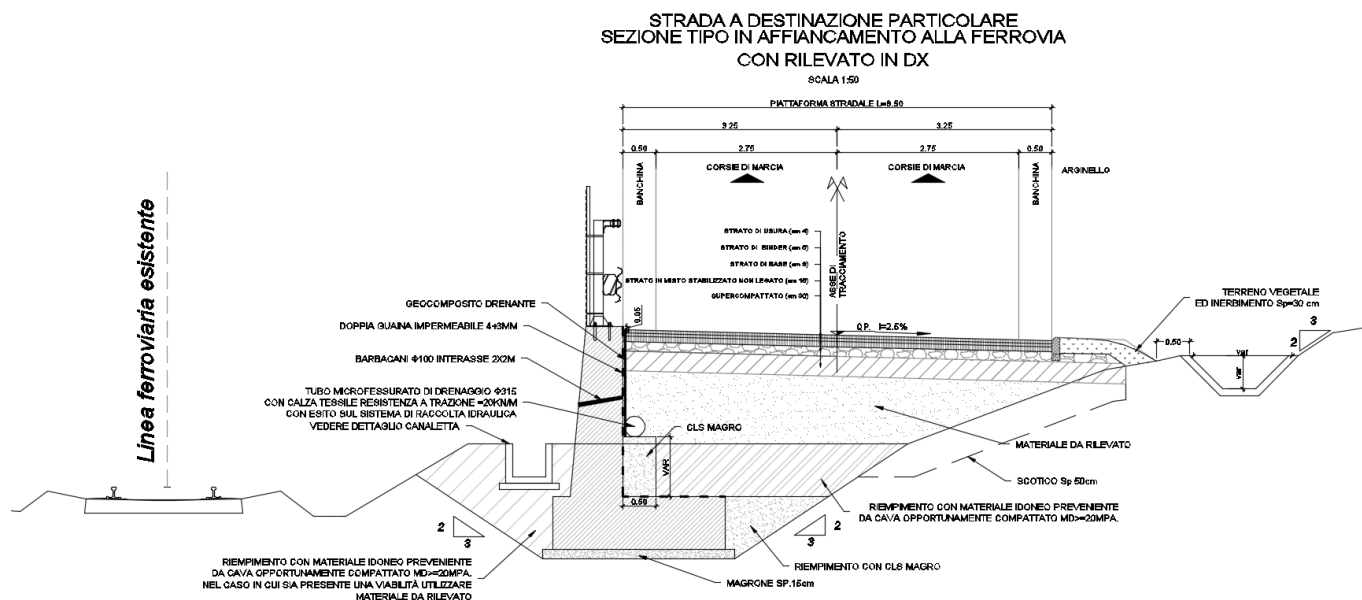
Asse 5 – Sezione tipo in affiancamento alla ferrovia con rilevato in DX
